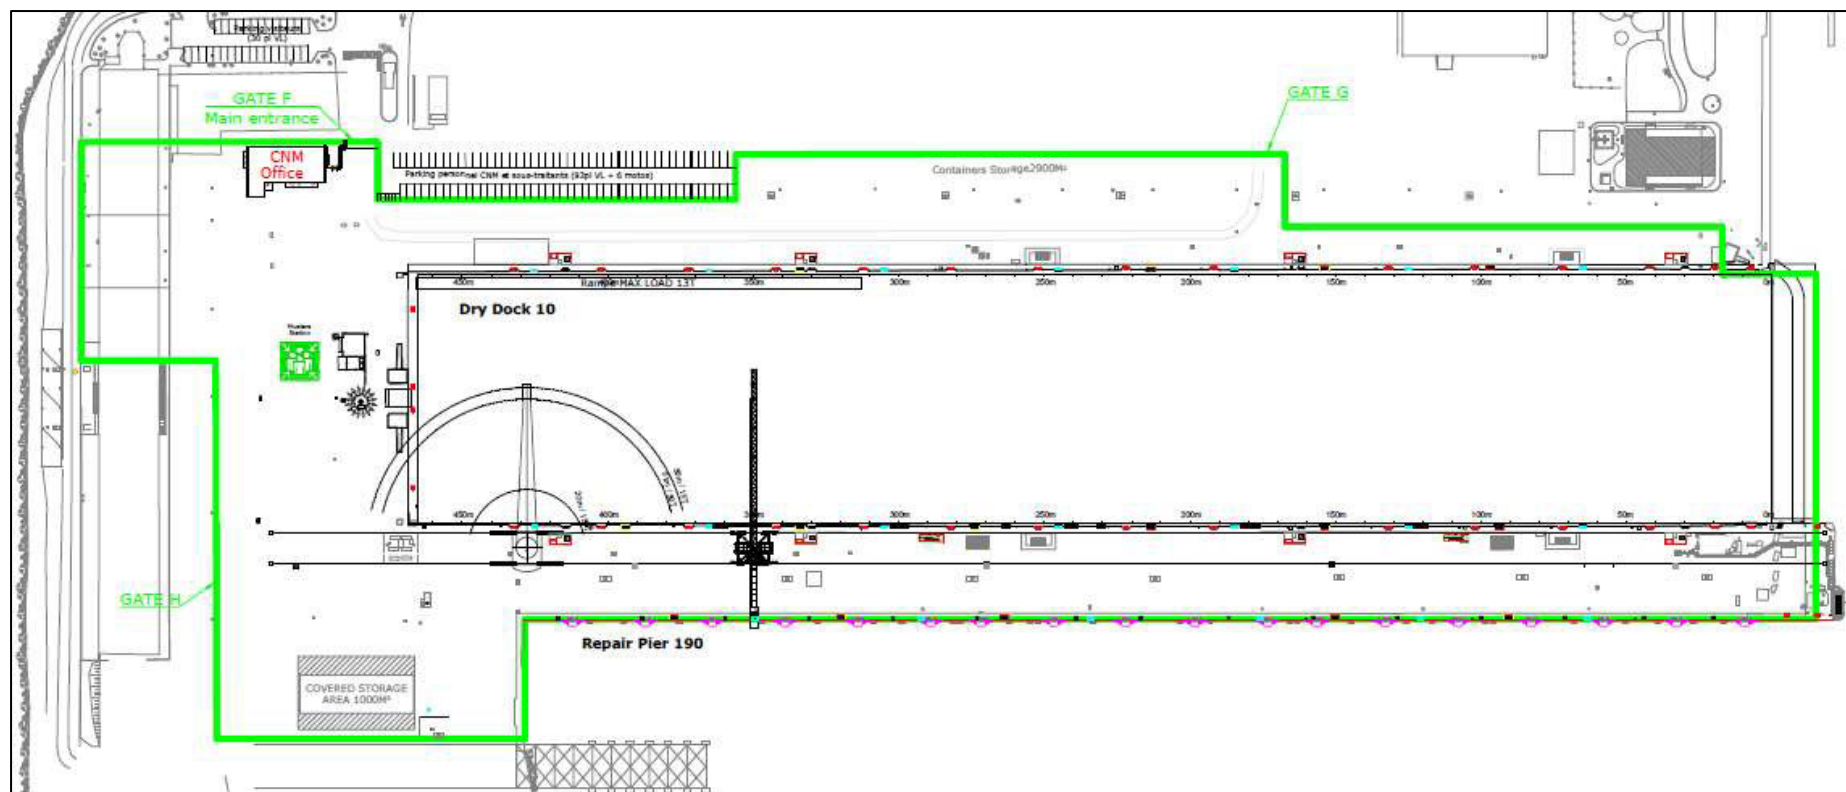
Plan général des installations sur l'enceinte du site CNM Forme 10
